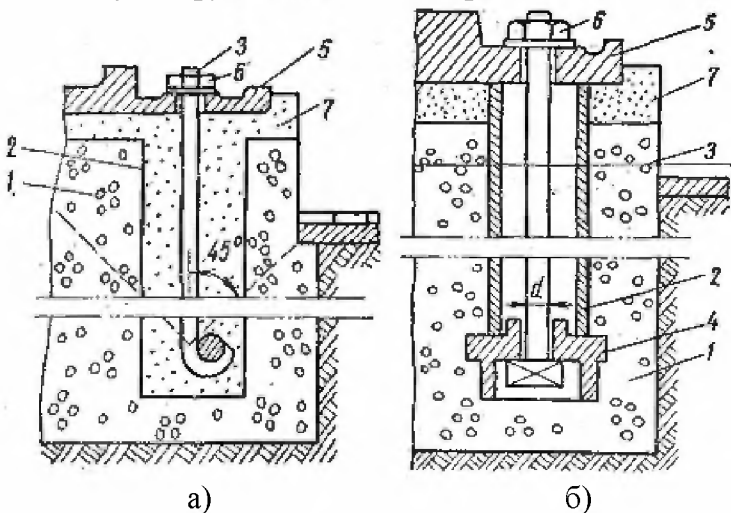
Засоби кріплення обладнання до фундаменту:
